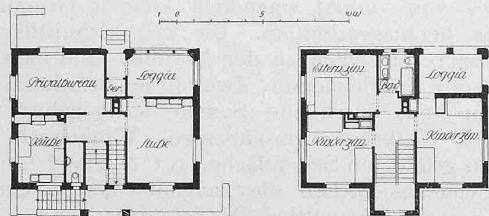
und 5. Grundrisse vom Erdgeschoss und Obergeschoss 1:400 des Einfamilienhauses Luisoni in Schlieren. Architekt J. B. Frisch in Zürich.
